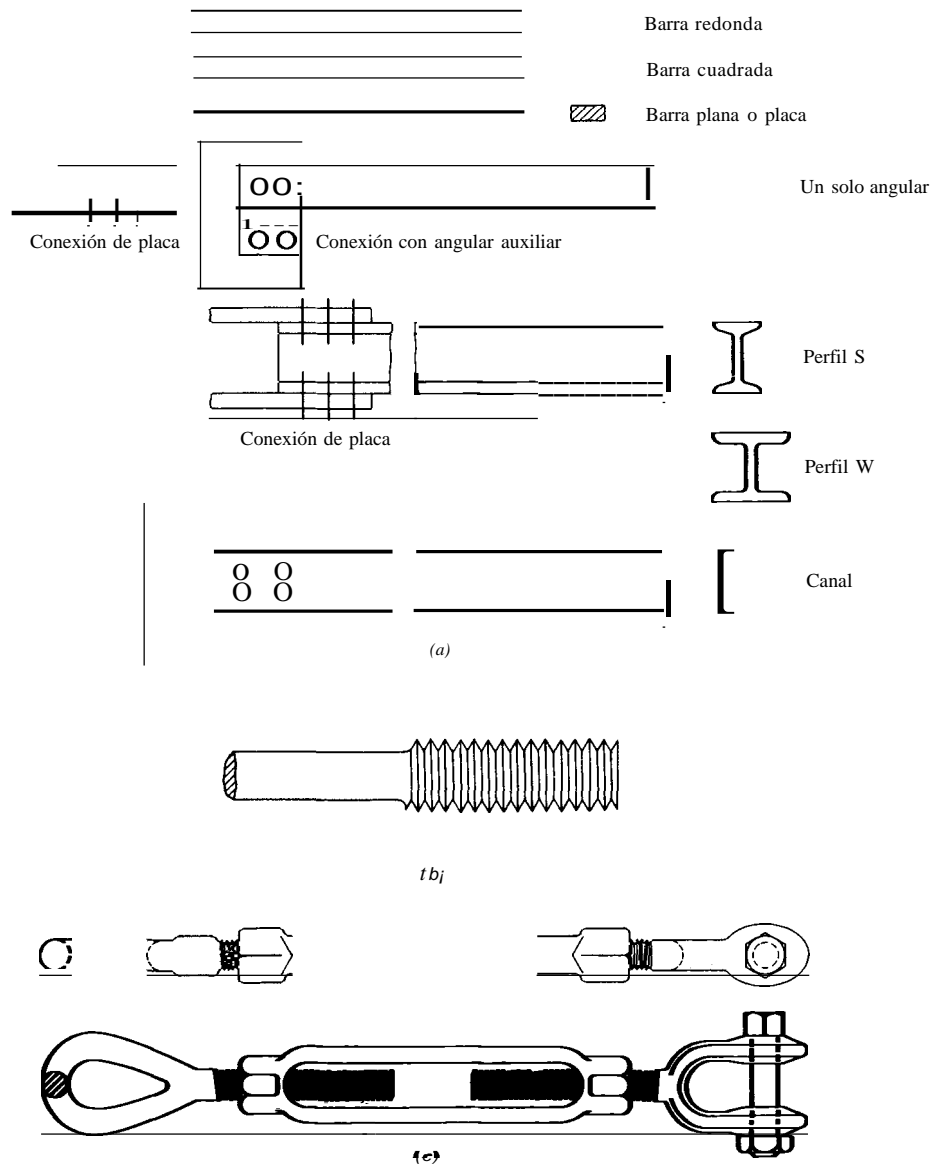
Miembros a tensión. Véase la figura 5-2 para cables usados como miembros a tensión. (a) Perfiles estructurales usados como miembros a tensión. (b) Barra con rosca sobrepuesta. (c) Barra roscada y uso de un templador para ajustar la longitud de la barra. Aplicable a barras cuadradas y redondas.
